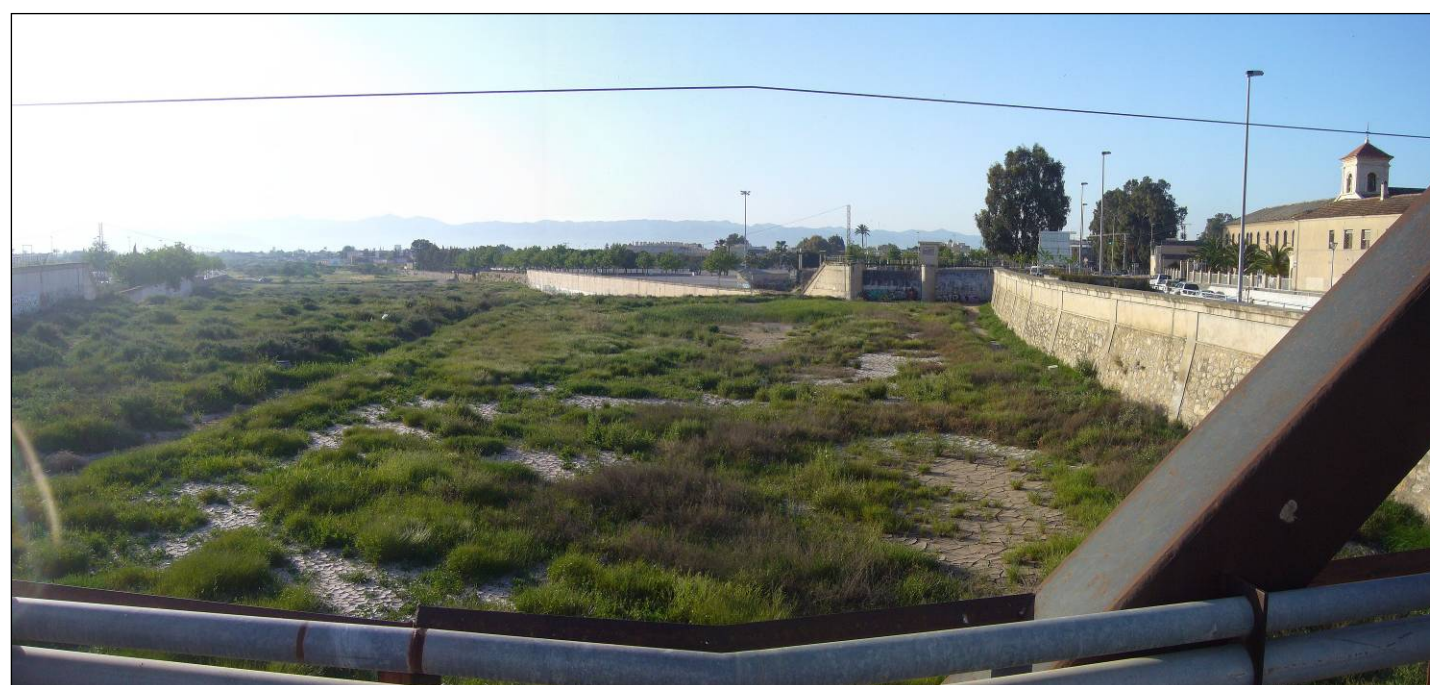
Otra vista del cauce del Guadalentín, desde el viaducto ferroviario, sentido sur. Se observa a la derecha el acceso al paso inferior de Santa Clara.
